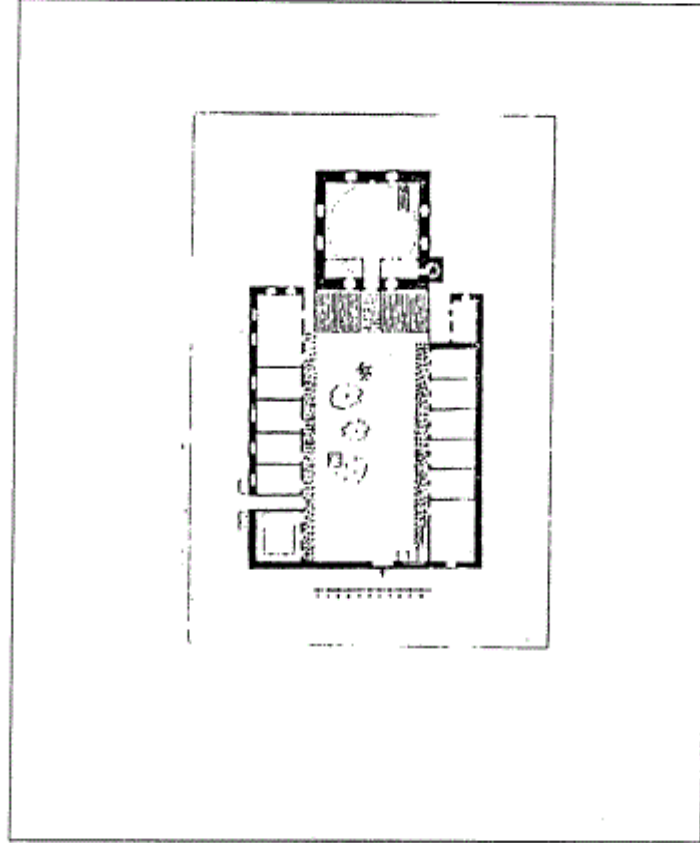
مسقط أفقي لمسجد الفاتح بعد تهيئته (عن : جابريل) .
